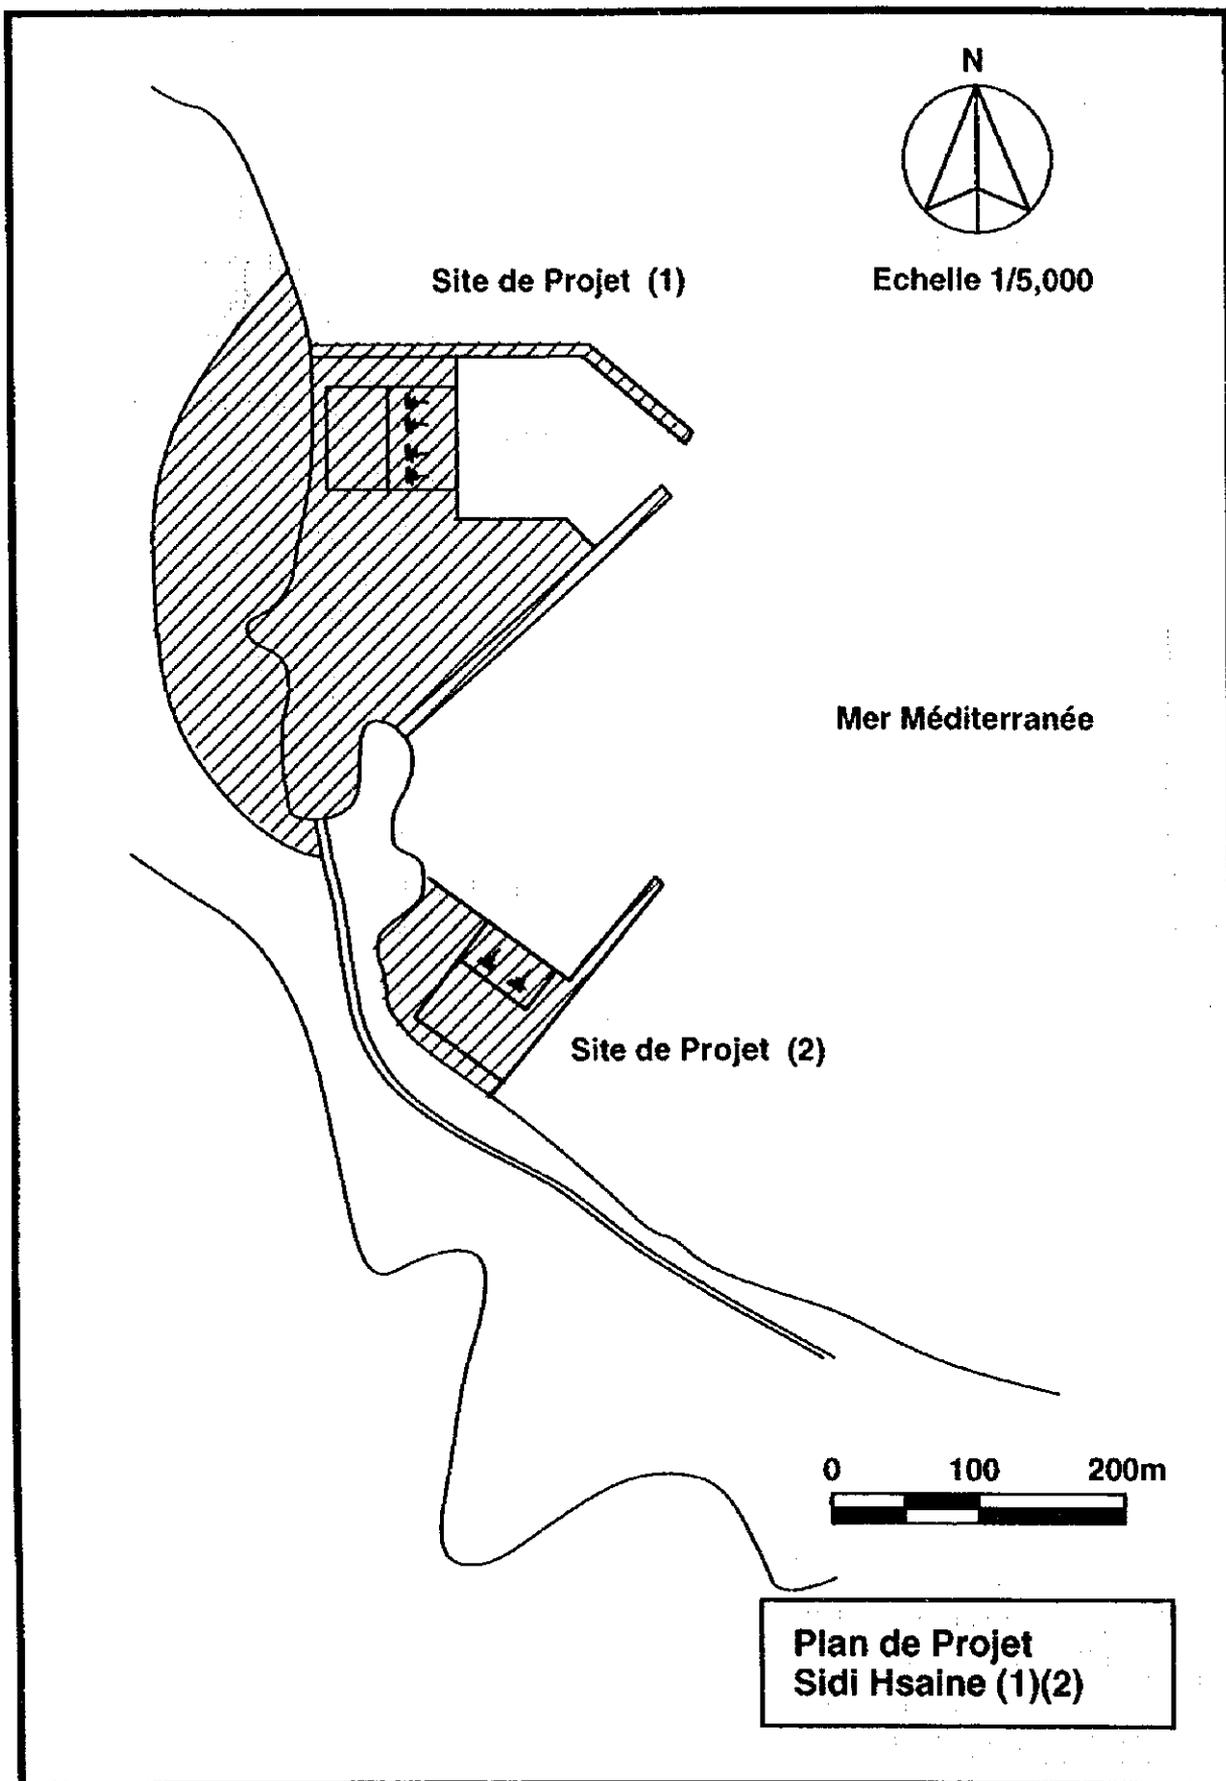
B-8 Projet de disposition des installations à Sidi Hsaine (ensemble)
